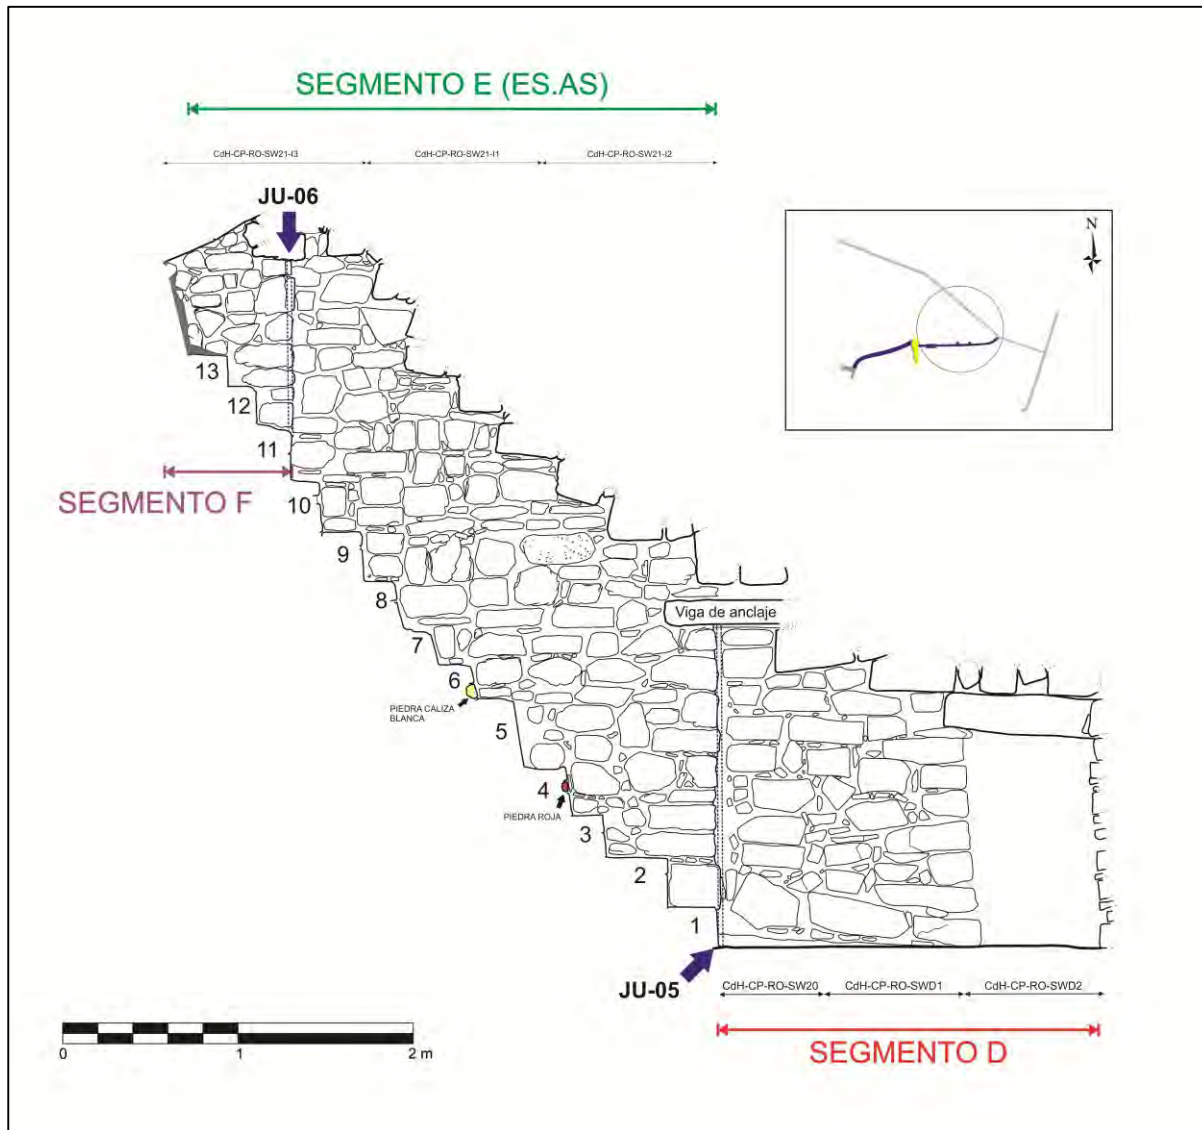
Corte longitudinal de la Sección II. Vista frontal de las paredes RL.02-W, ES.AS-W y ES.AS-W.
